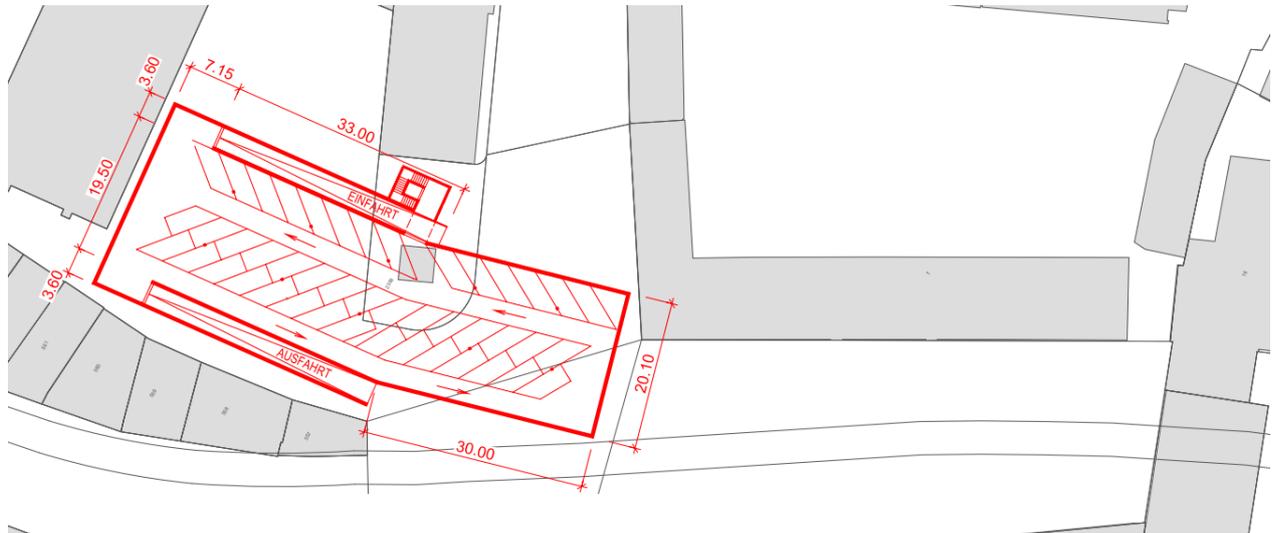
Ausschnitt Situation Variante Franziskaner 1.1 Grundriss Parkgeschoss
